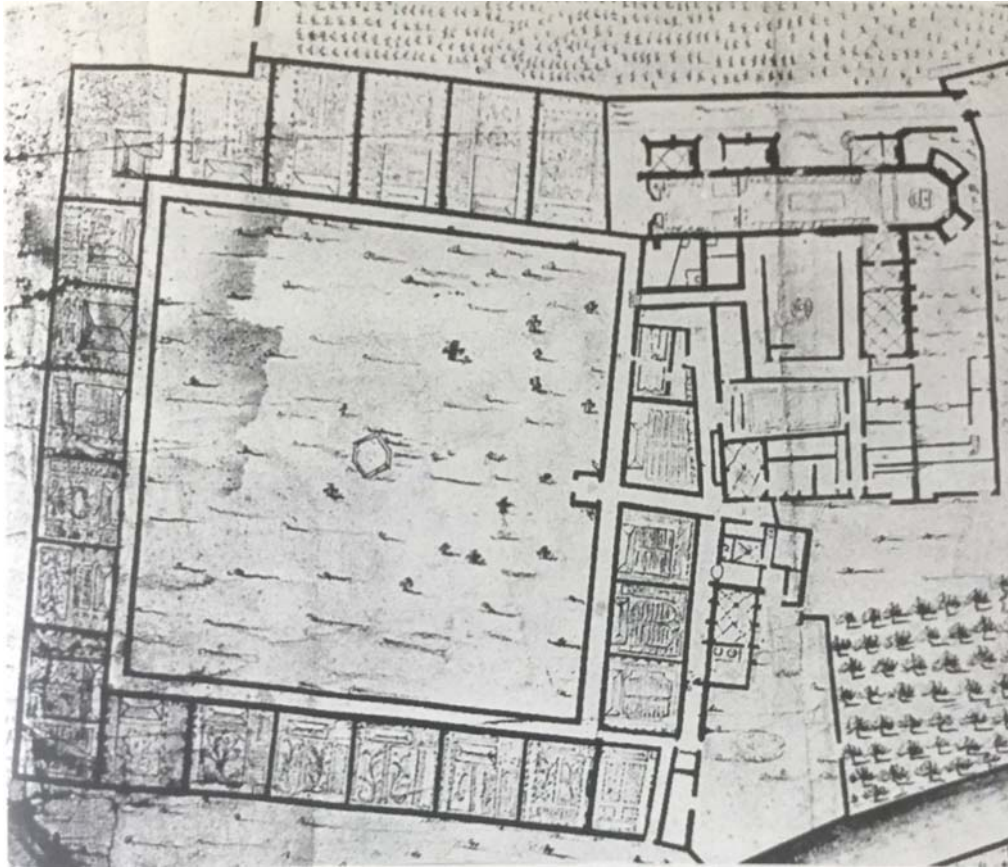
Grundrissplan der Kartause Champmol – um 1760
